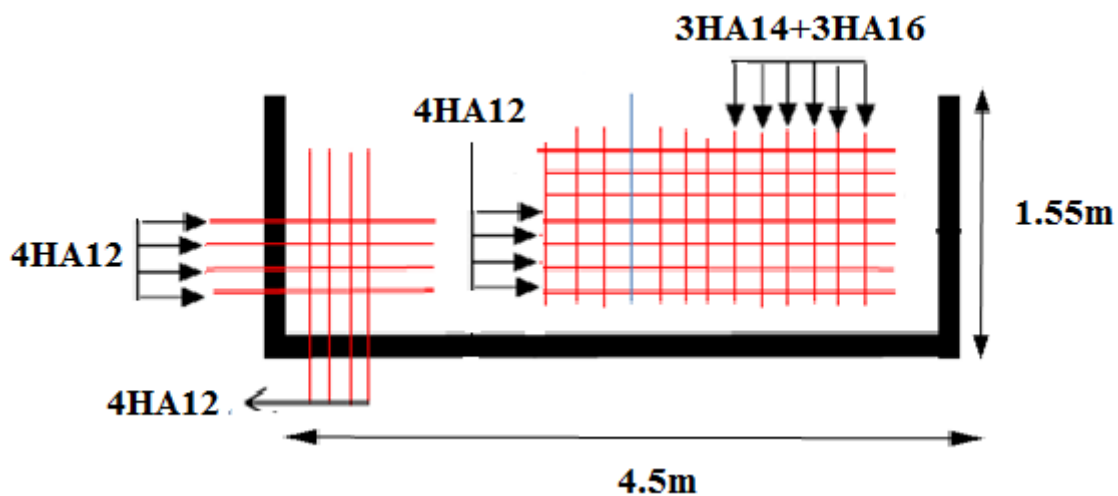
Schéma de ferrailage de la dalle pleine sur trois appuis.
